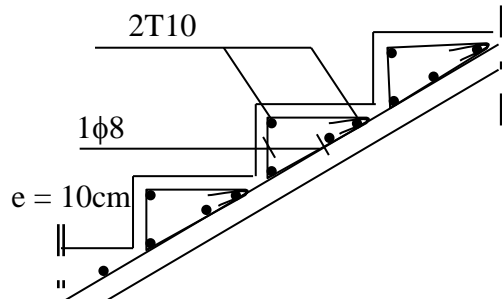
Dessin du ferrailage de la marche porteuse
